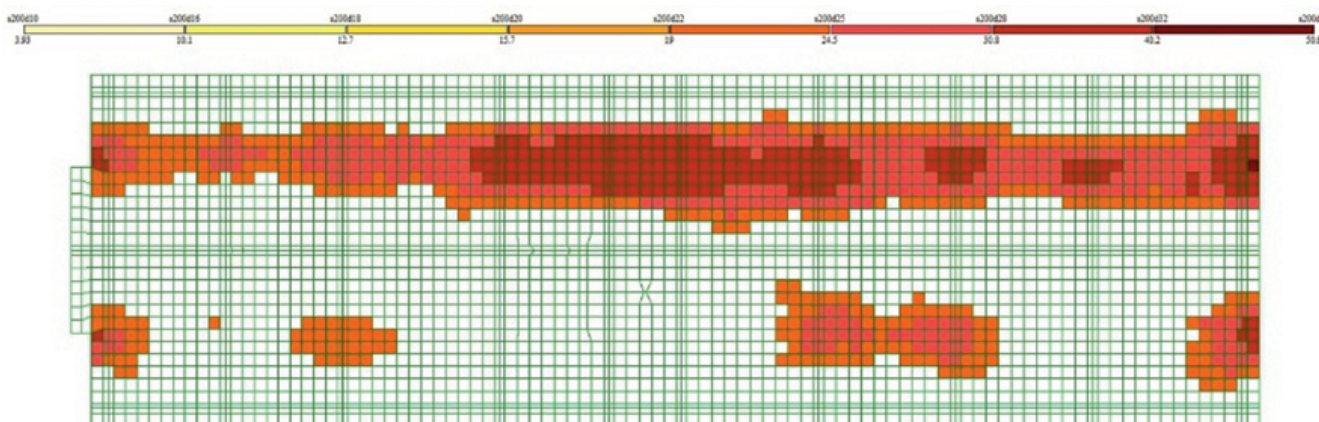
Армирование верхней грани вдоль оси Y (арматура Ав500П)
